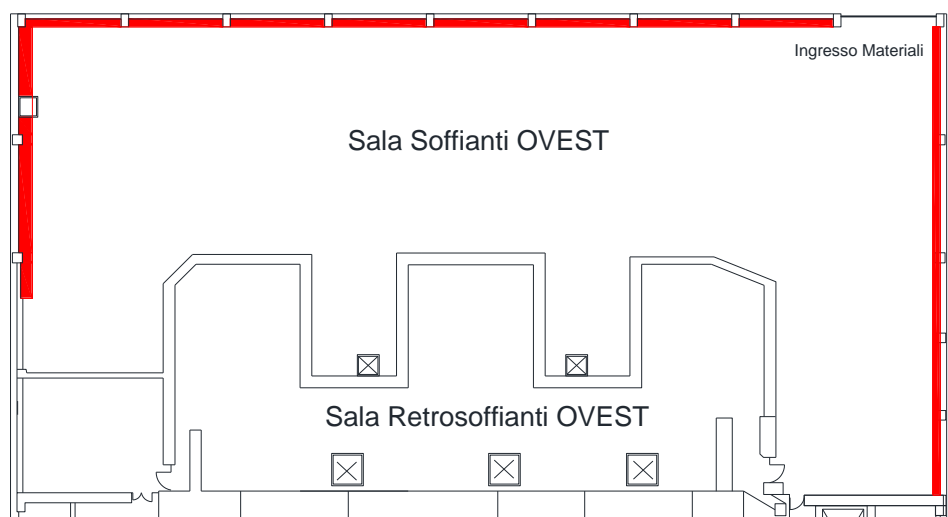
Planimetria Edificio Reattore quota 6,70 m s.l.m.m - strutture portanti di rinforzo strutturale
